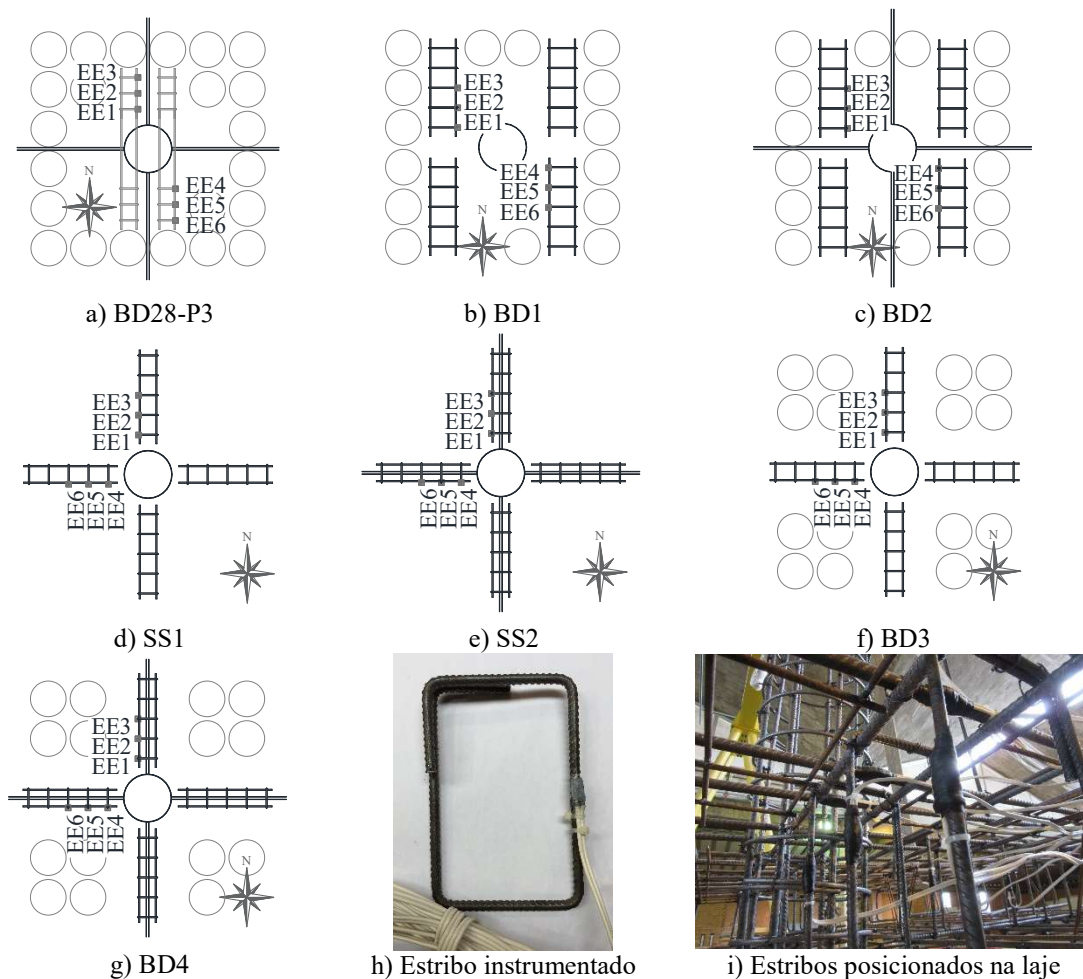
Posição dos extensômetros dos estribos (EE) – vista em planta
